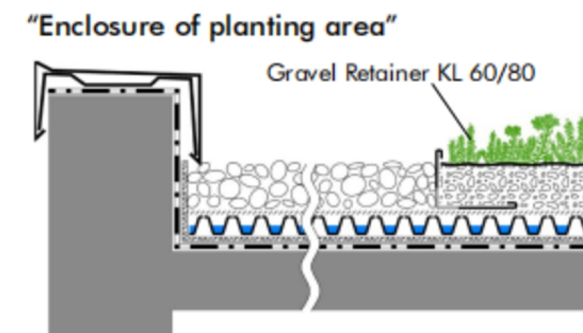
Pormenor-tipo da transição entre faixa em gravilha e zona verde
